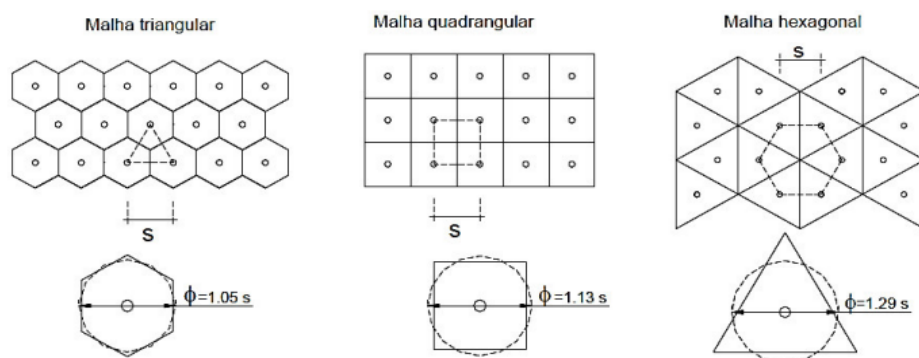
Diferentes disposições em planta para colunas de brita (Domingues, 2006)
